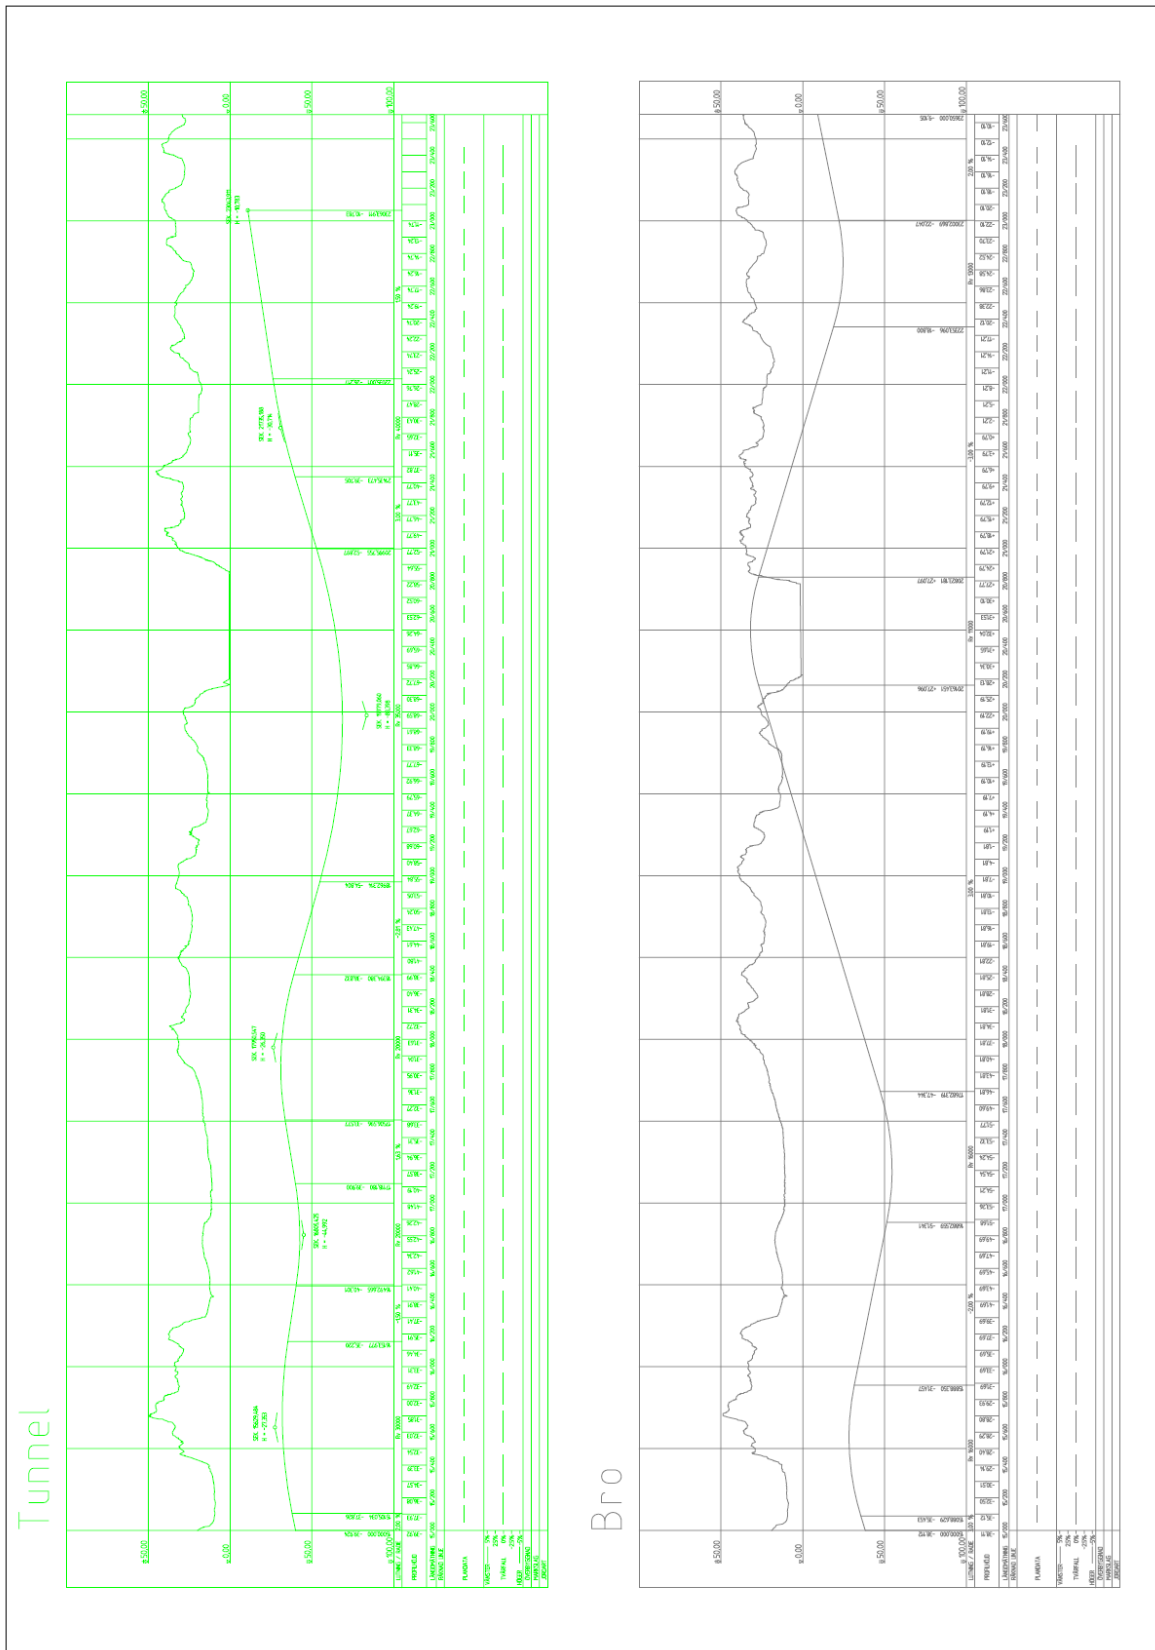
Profil för alternativ tunnel samt alternativ bro.
